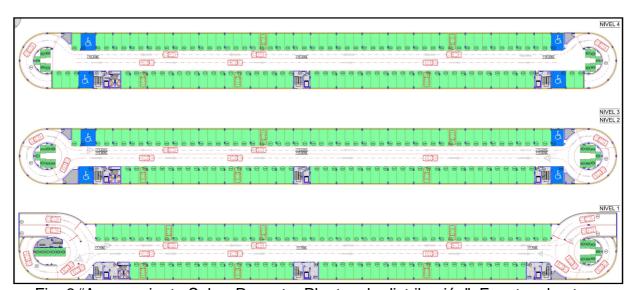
"Aparcamiento Sobre Rasante. Plantas de distribución". Fuente: el autor.
